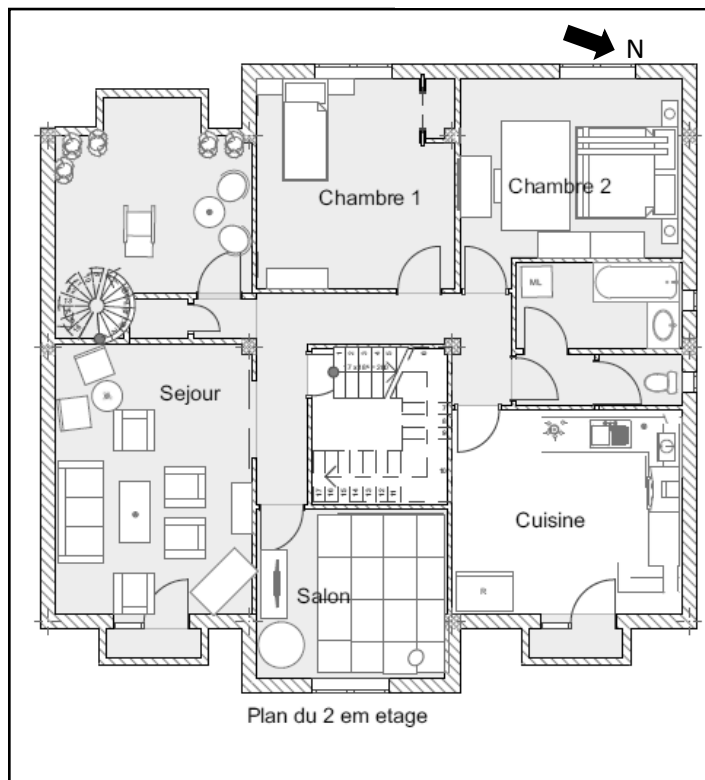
plan 2em étage ech 02 (source : auteur)
